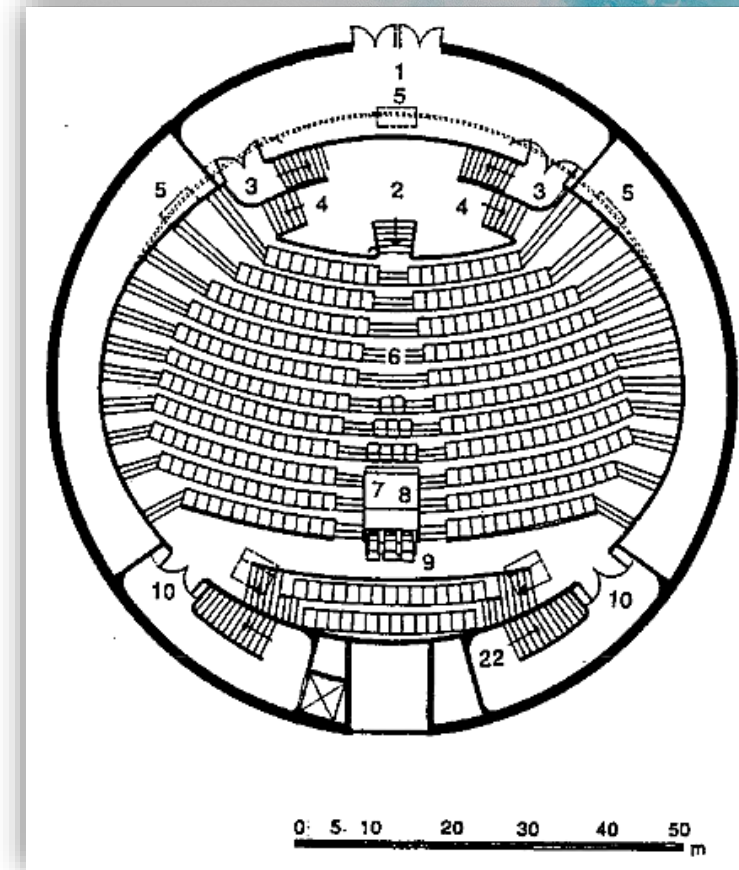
Planetario Alfa. Planta Arquitectónica
